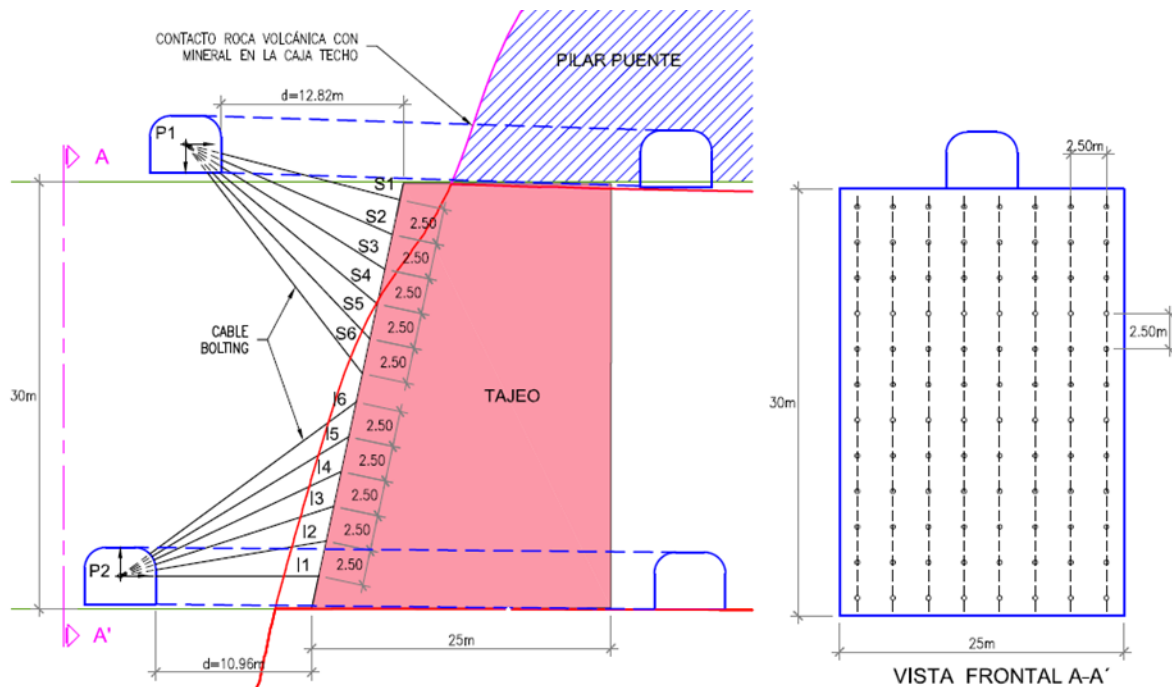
Esquema de diseño de cable bolting en la zona de contacto con la caja techo cercana.
